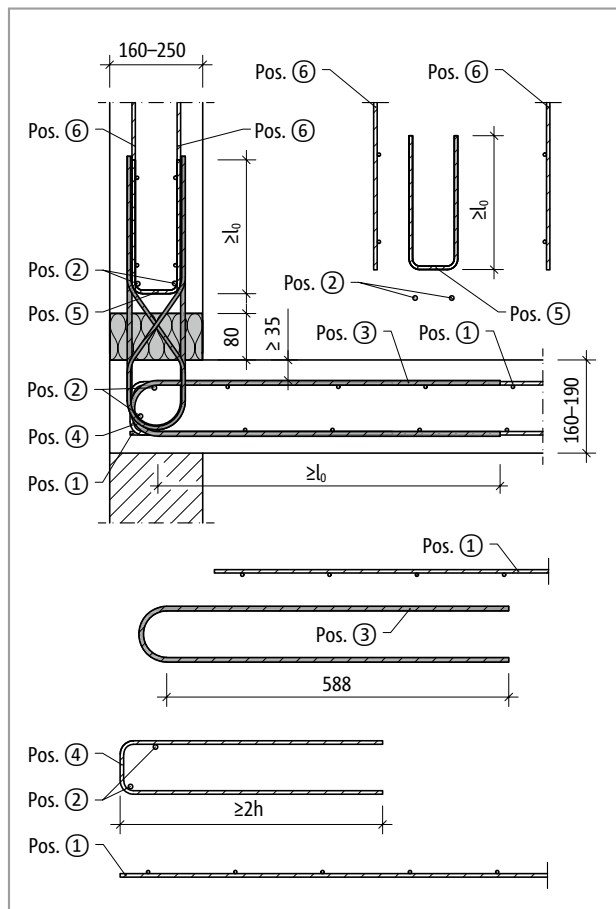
Schöck Isokorb® T tipo A: Armadura in situ interior
